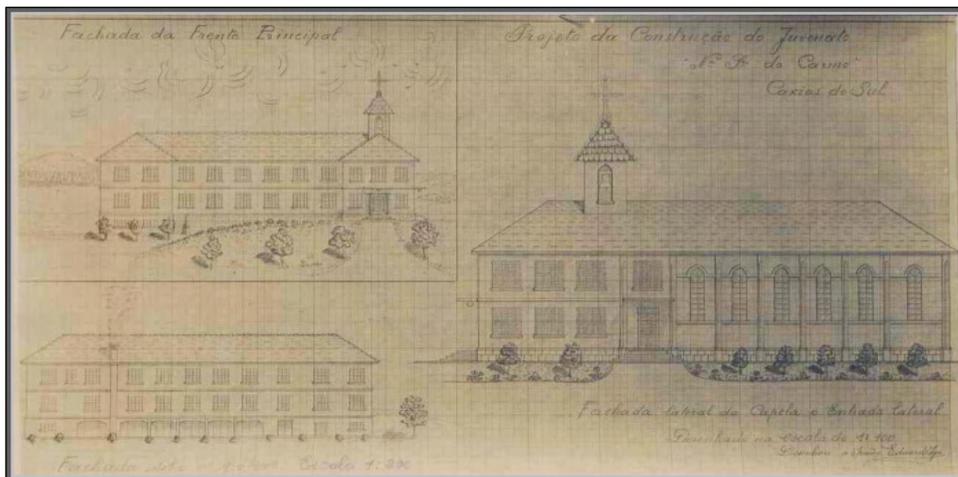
Projeto da construção do Ginásio Nossa Senhora do Carmo.
